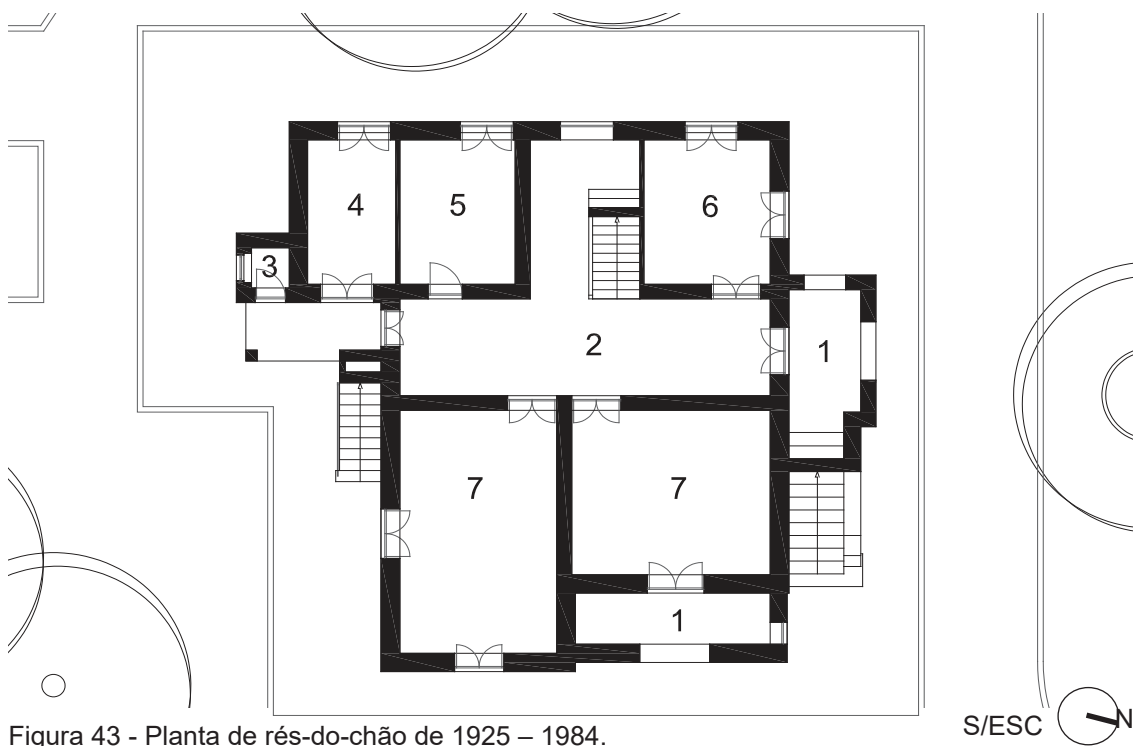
Planta de rés-do-chão de 1925 – 1984.
